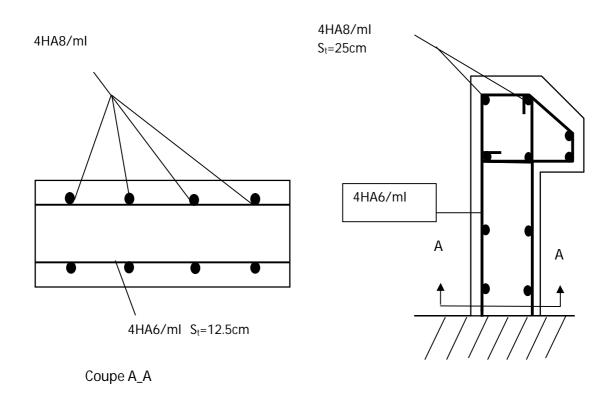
Schéma de ferraillage de l'acrotère 01
